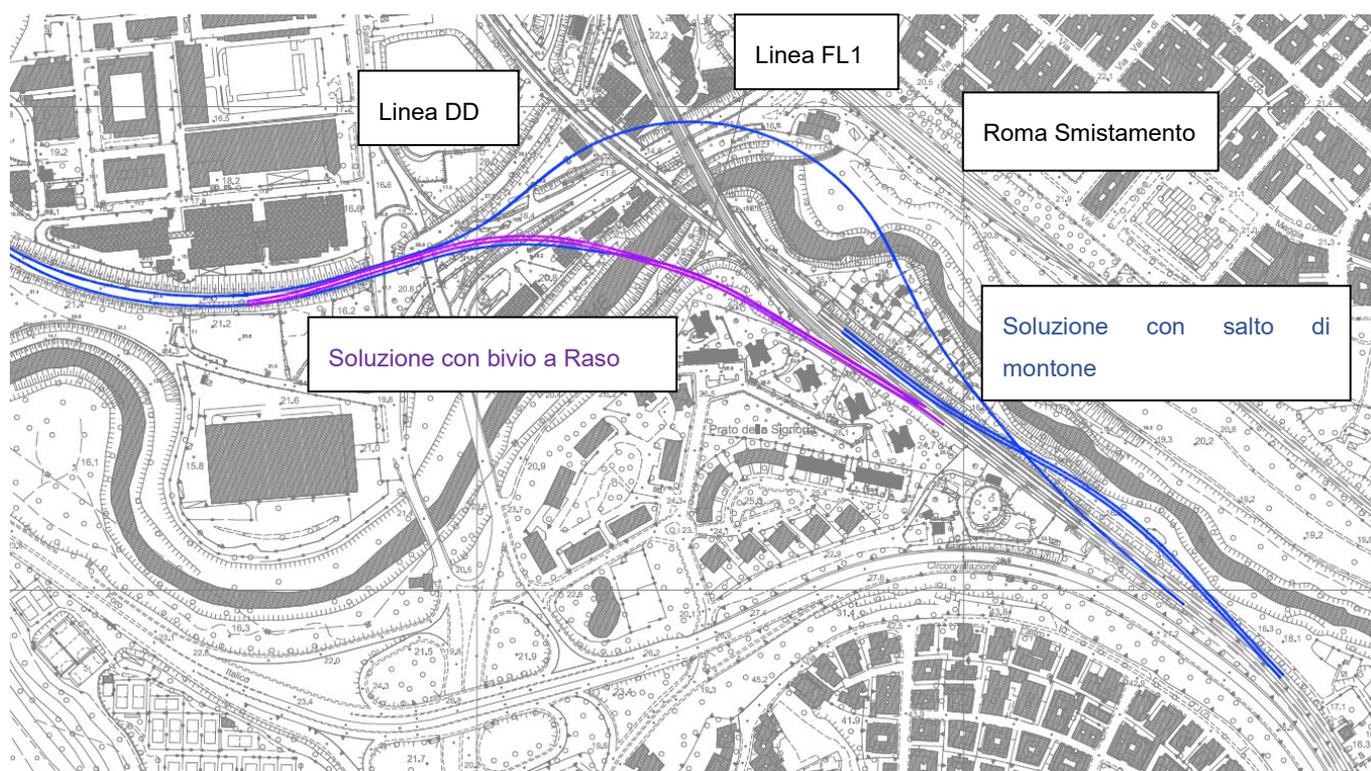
inquadramento planimetrico zona con predisposizione della chiusura dell'Anello
